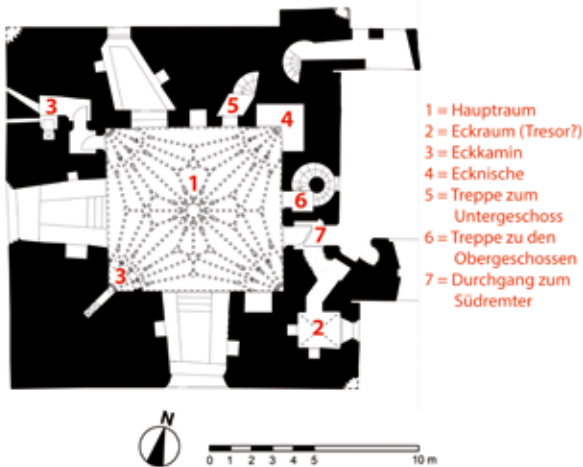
(oben) Burg in Wenden, Grundriss des ‚Landmeistergemachs‘
